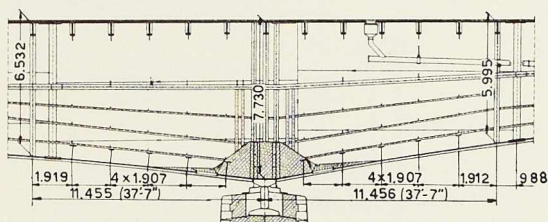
Vue intérieure des poutres extrêmes dans la zone des piles en rivière.
